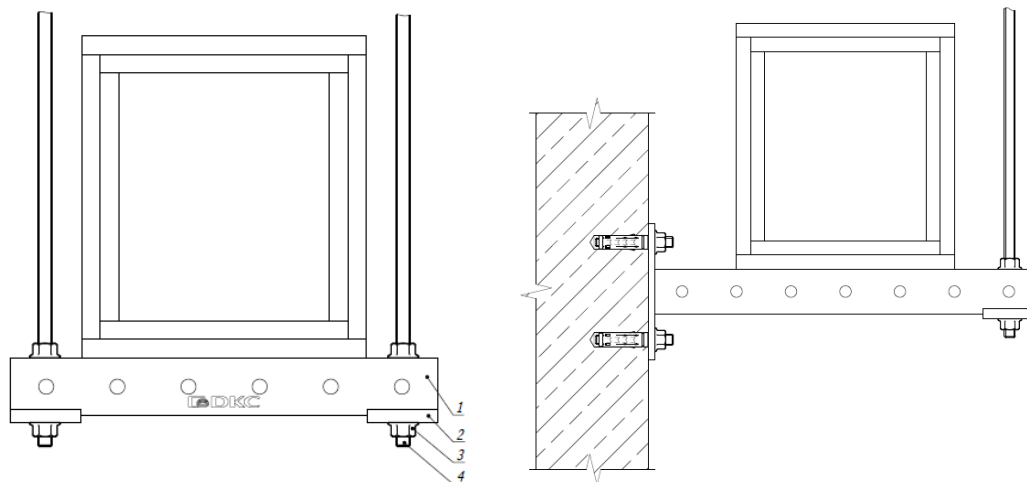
Крепление короба с четырьмя стенками к несущей поверхности
